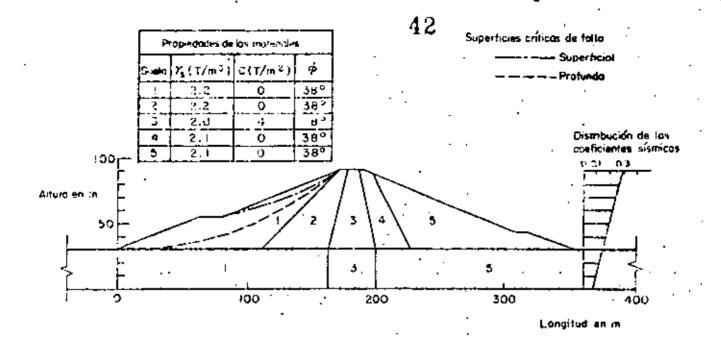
Característicos de los materiales y geometría de la Preso La Villita (Ref. # 3)
